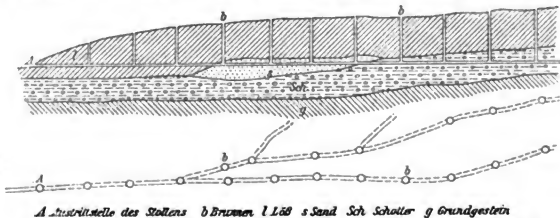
System eines Kjāris (nach Zimbalenko); oben Längsprofil, unten Grundriss.
